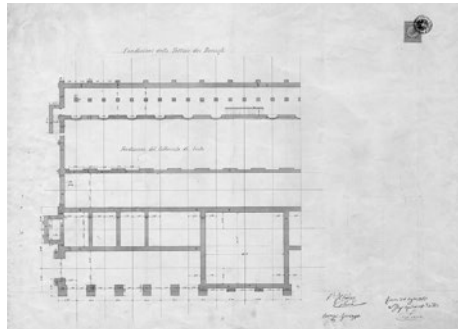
Tiro al Bersaglio. Pianta delle fondazioni, 6 luglio 1865 (ASCT, Tipi e disegni, 21.3.41).
